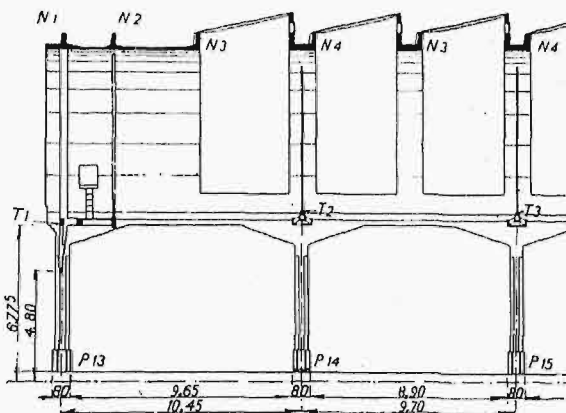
Przekrój poprzeczny hali poprzez łuki żelbetowe. Widoczne są słupki i poręcz dla ułatwienia dostępu do czyszczenia świetlików.
